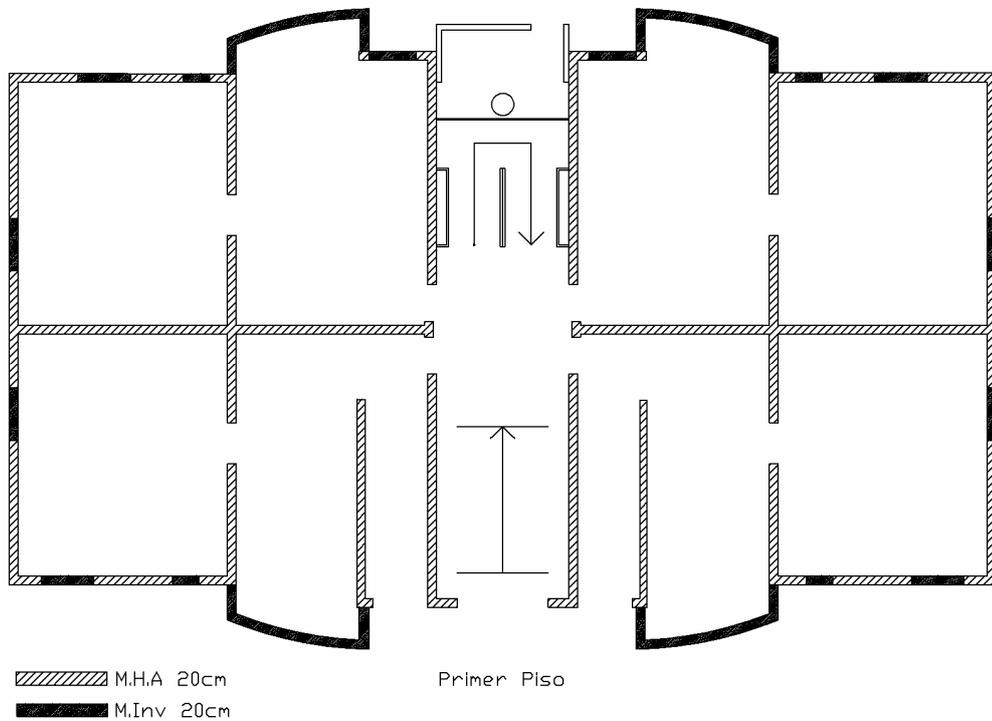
Edificios A y E, estructuración del Piso Tipo.
